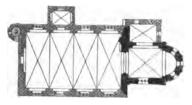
Schaprode. Kirche. Grundriss. 1:667.
